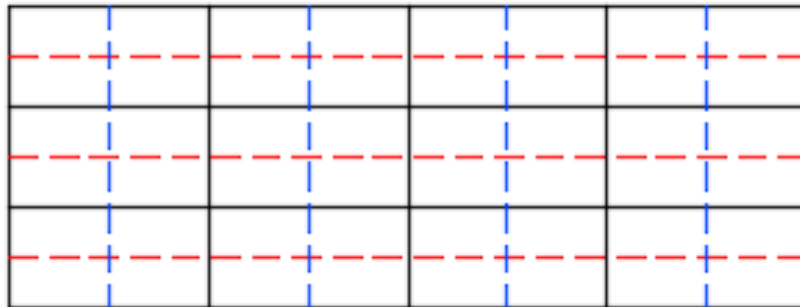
Vista en planta, distribución de cargas de manera uniforme.
